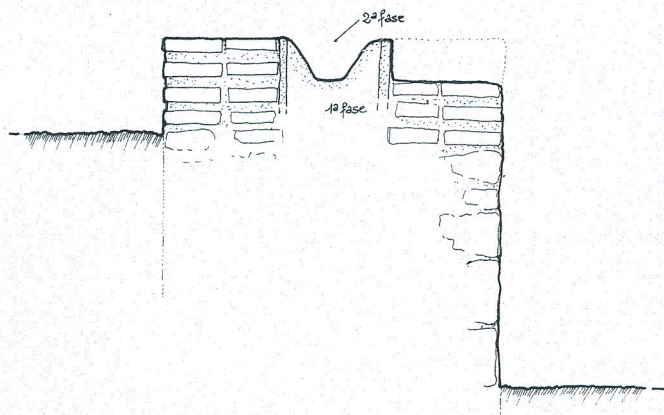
SPALLE DI UN PONTE-CANALE DEL RAMO C.
